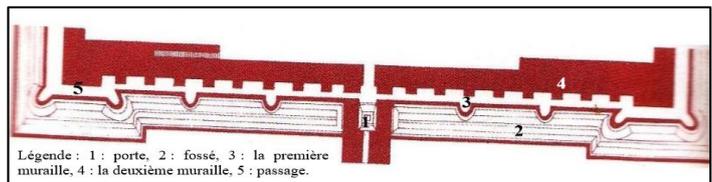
Reconstitution du plan de la forteresse haute de MIRGISSA, Egypte
